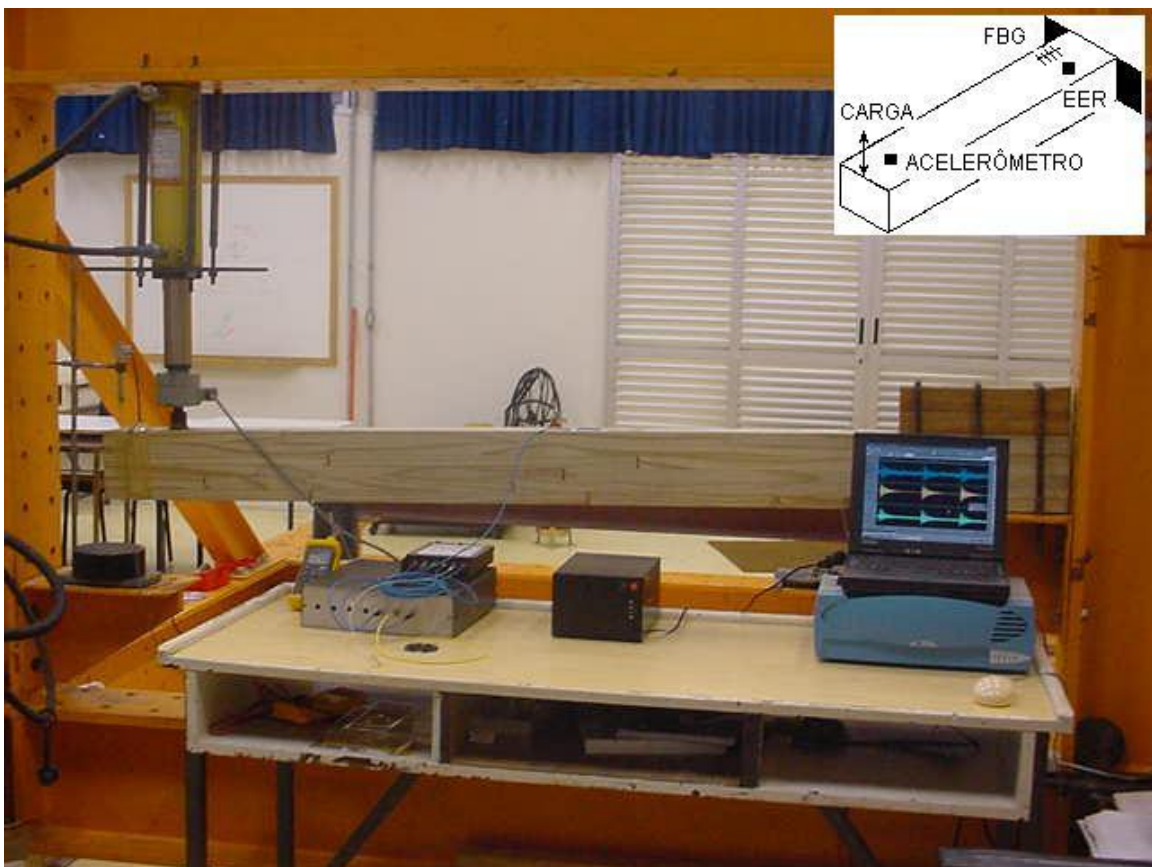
Arranjo de ensaio e instrumentação da viga
